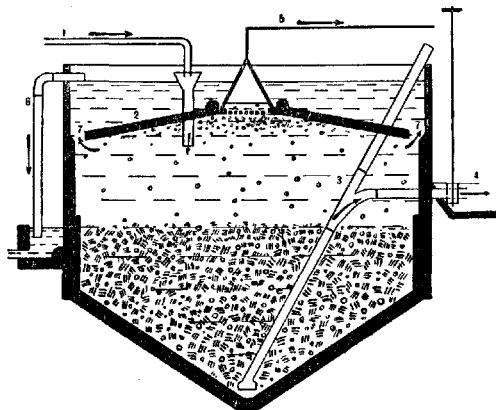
Резервуар для отдельного выбраживания осадка («метан-танк»): 1—впуск «свежего» осадка; 2—железобетонное перекрытие с отверстием, закрытым деревянной решеткой; 3—иловая труба для перегибания осадка; 4—супп. площадка; 5—газопровод из колпака; 6—спусная труба для излишка жидкости; 7—отверстия для выхода излишка жидкости.
